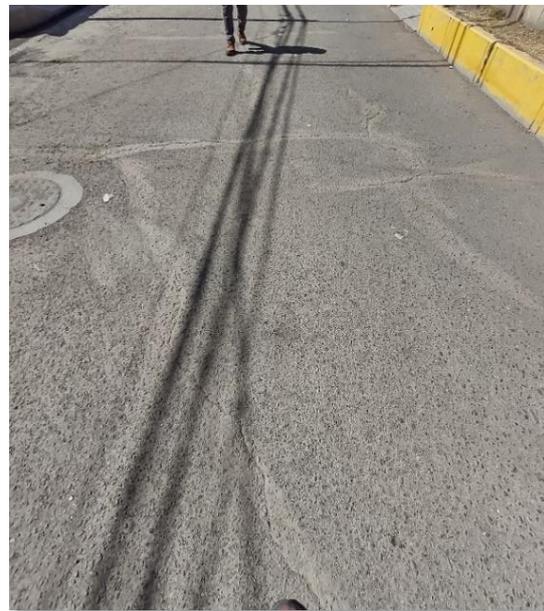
Fisuras en bloque, severidad media.
